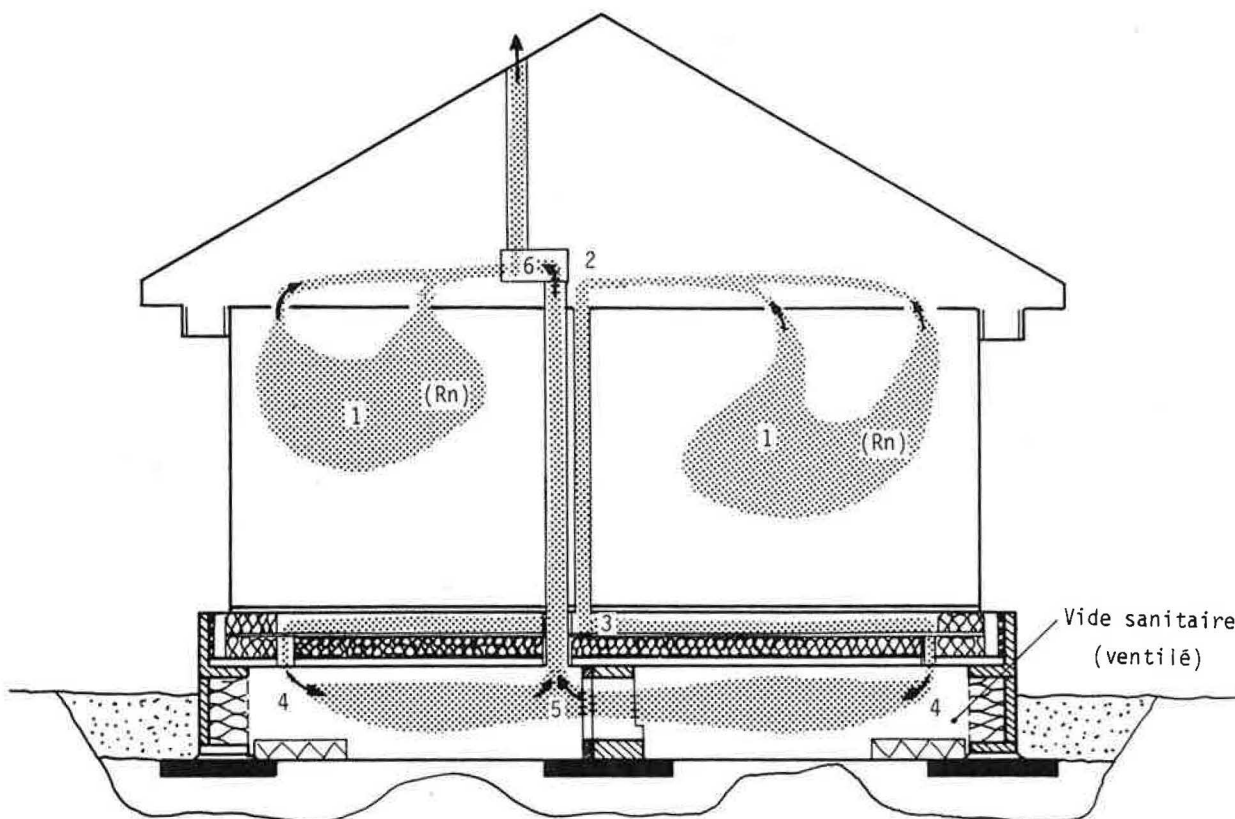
Exemple de construction saine sur un site favorable au Radon.
